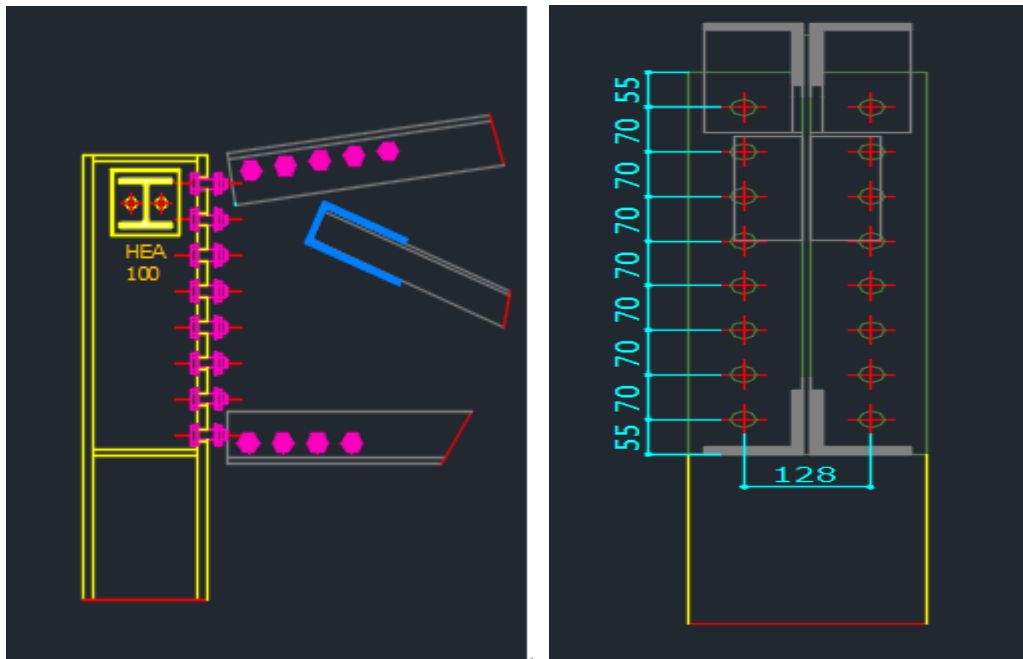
assemblage poteau HEB 240 avec élément de treillis
